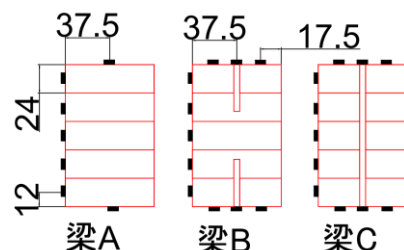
ひずみゲージ貼付位置 (寸法単位:mm)
